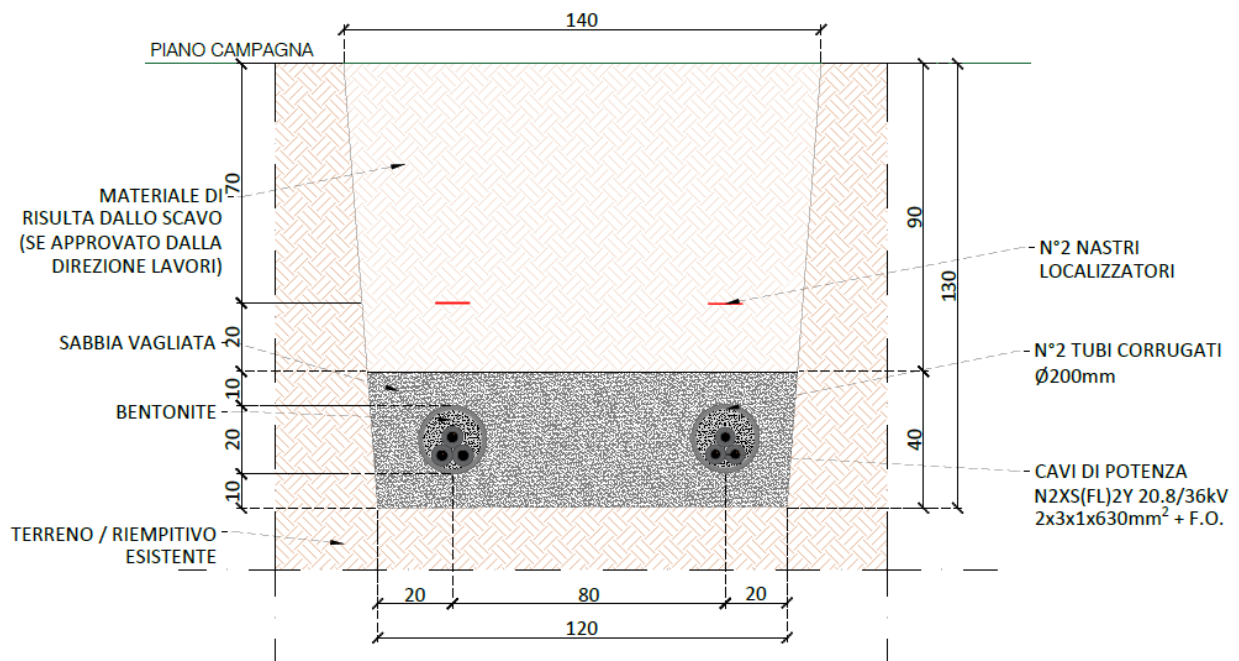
Sezione tipica di scavo tratto terminale per collegamento in stazione elettrica
